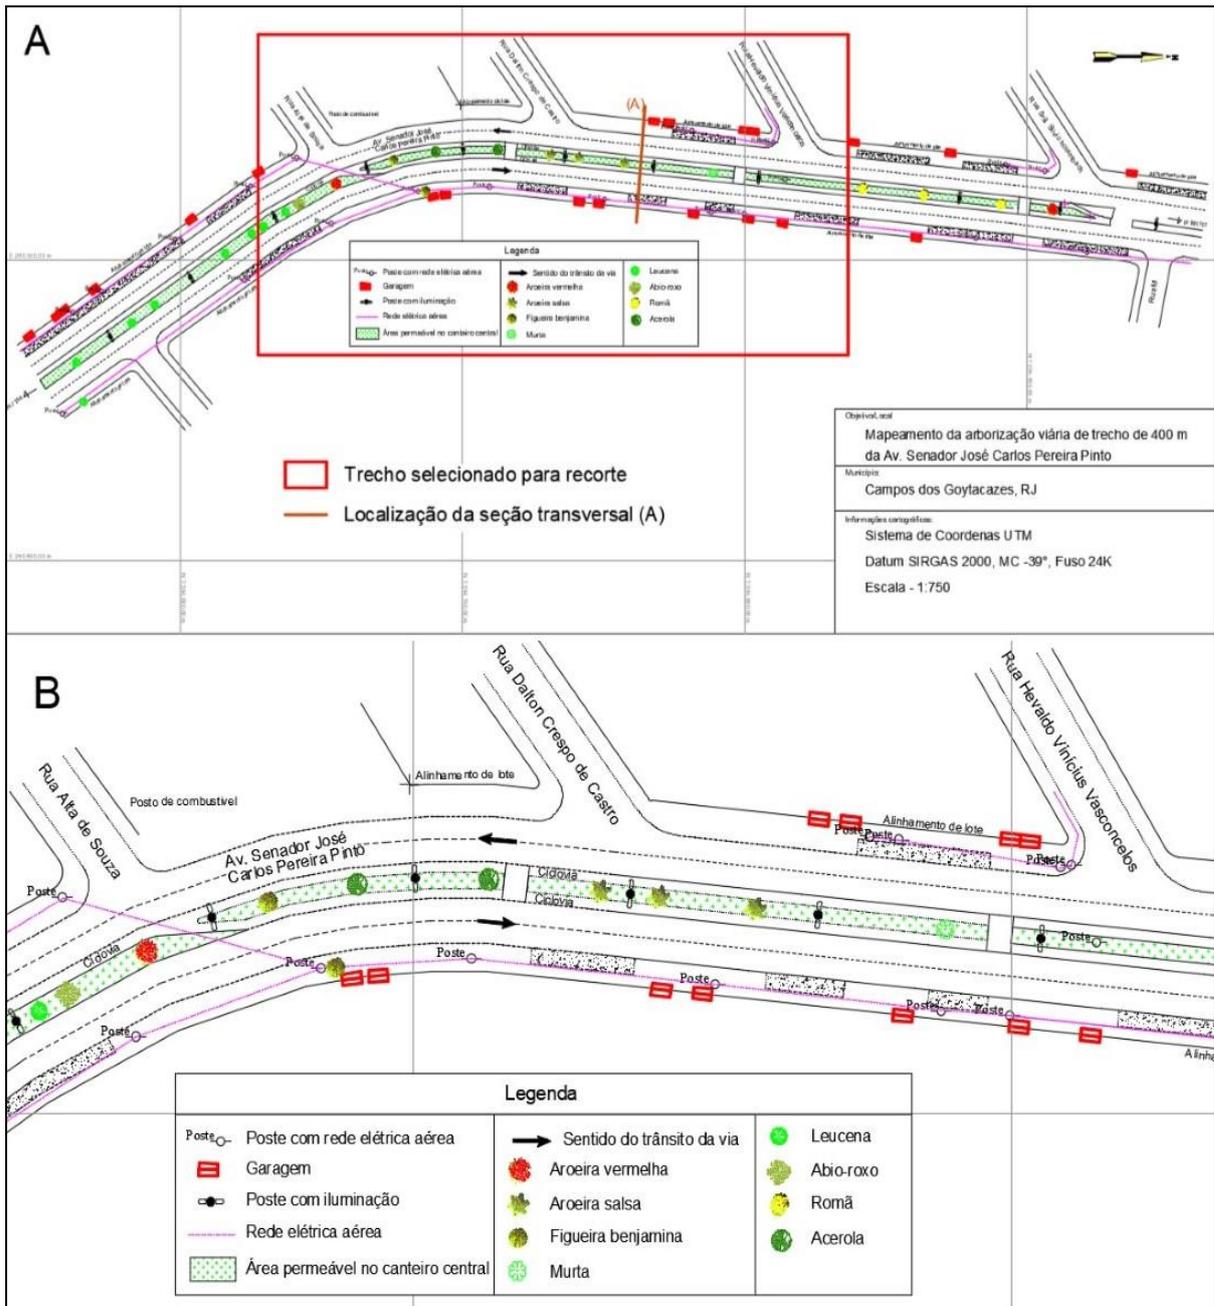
Trechos da avenida Senador José Carlos Pereira Pinto. (A) Planta do trecho selecionado para proposta de melhorias da arborização. (B) Recorte da planta topográfica do trecho selecionado para proposta de arborização.
